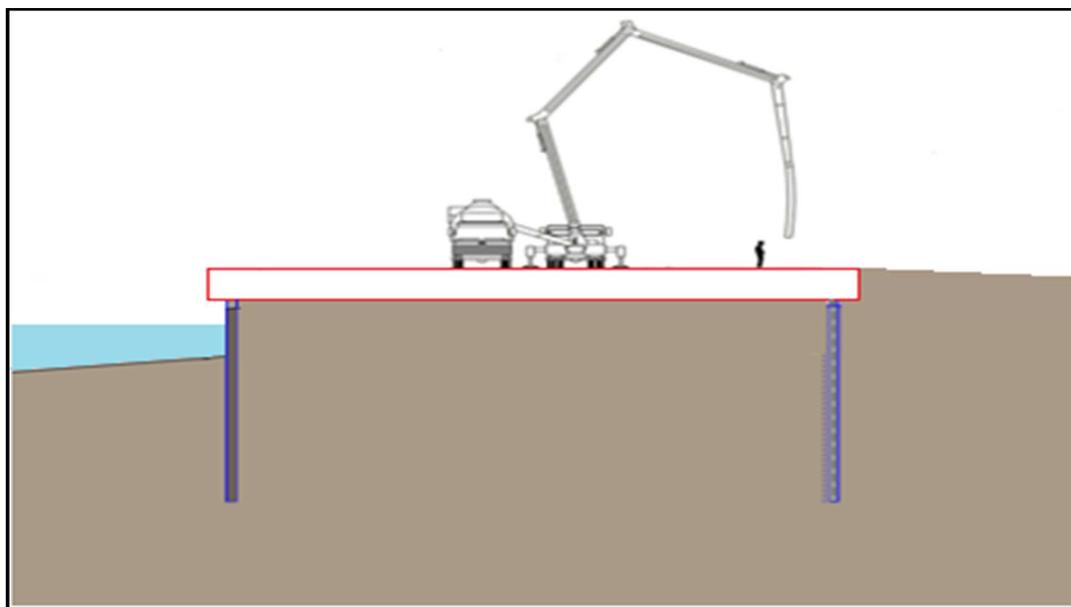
Esecuzione trave di coronamento e pavimentazione
